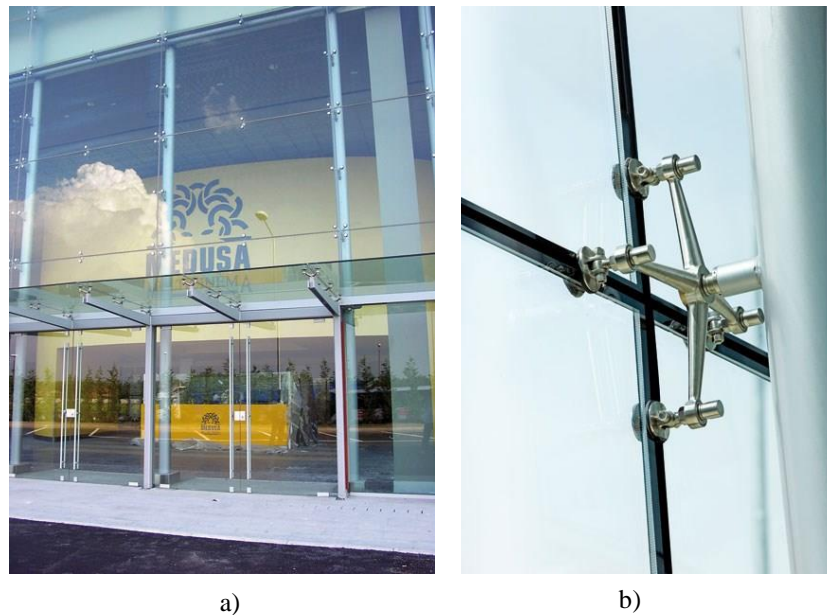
a) Fachada e cobertura em vidro exterior agrafado; b) Exemplo de ligação aparafusada (Archiproducts, s.d.)
